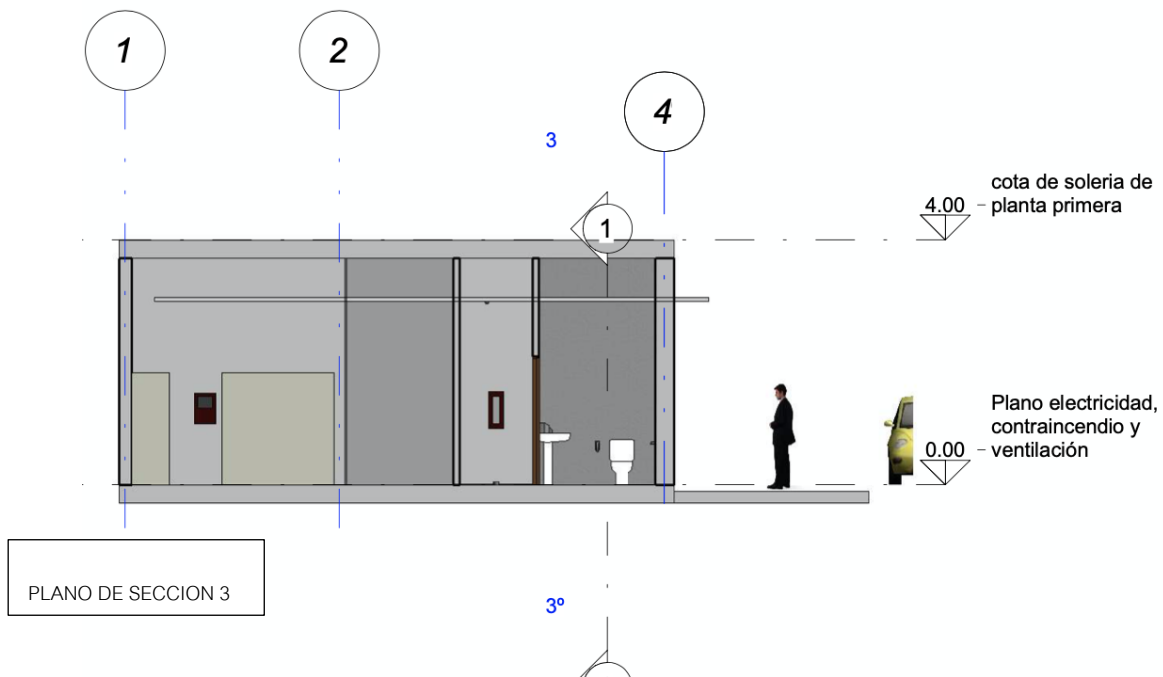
Plano de sección 3. Fuente: Propia y Revit®
